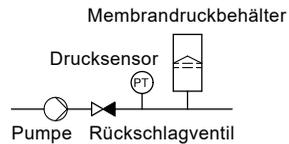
Position des Rückschlagventils und des Drucksensors in Anlagen mit positivem Zulaufdruck
